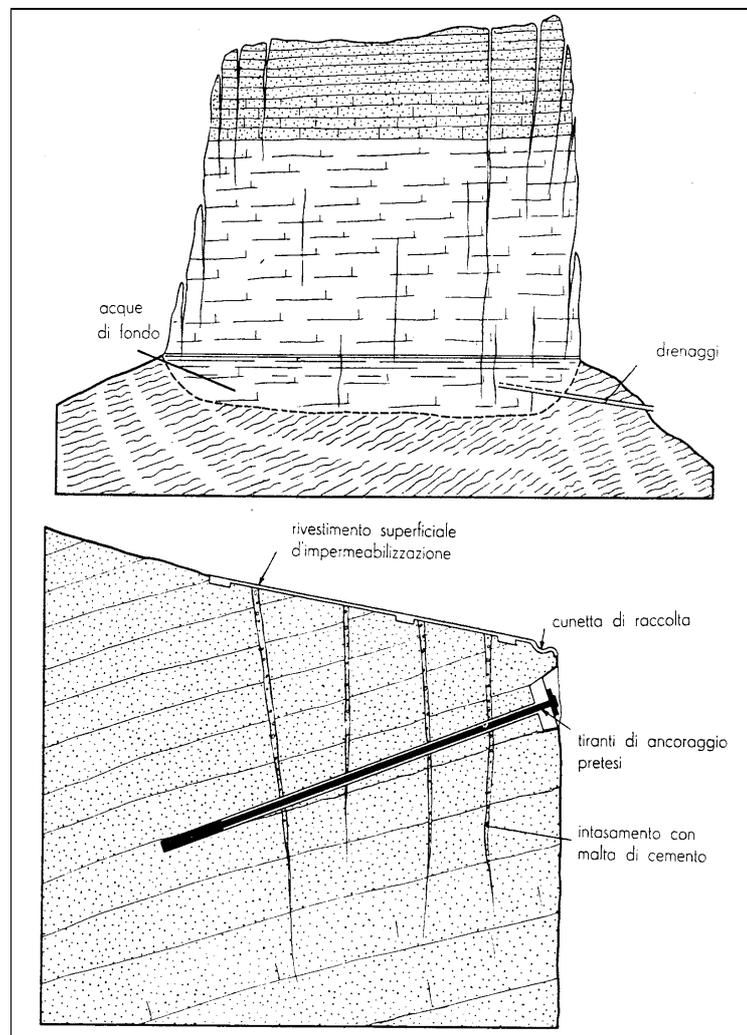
Sezioni con indicazione schematica dei provvedimenti di stabilizzazione: impermeabilizzazione superficiale, sigillatura delle fessure, ancoraggi della parete e tubi drenanti.
